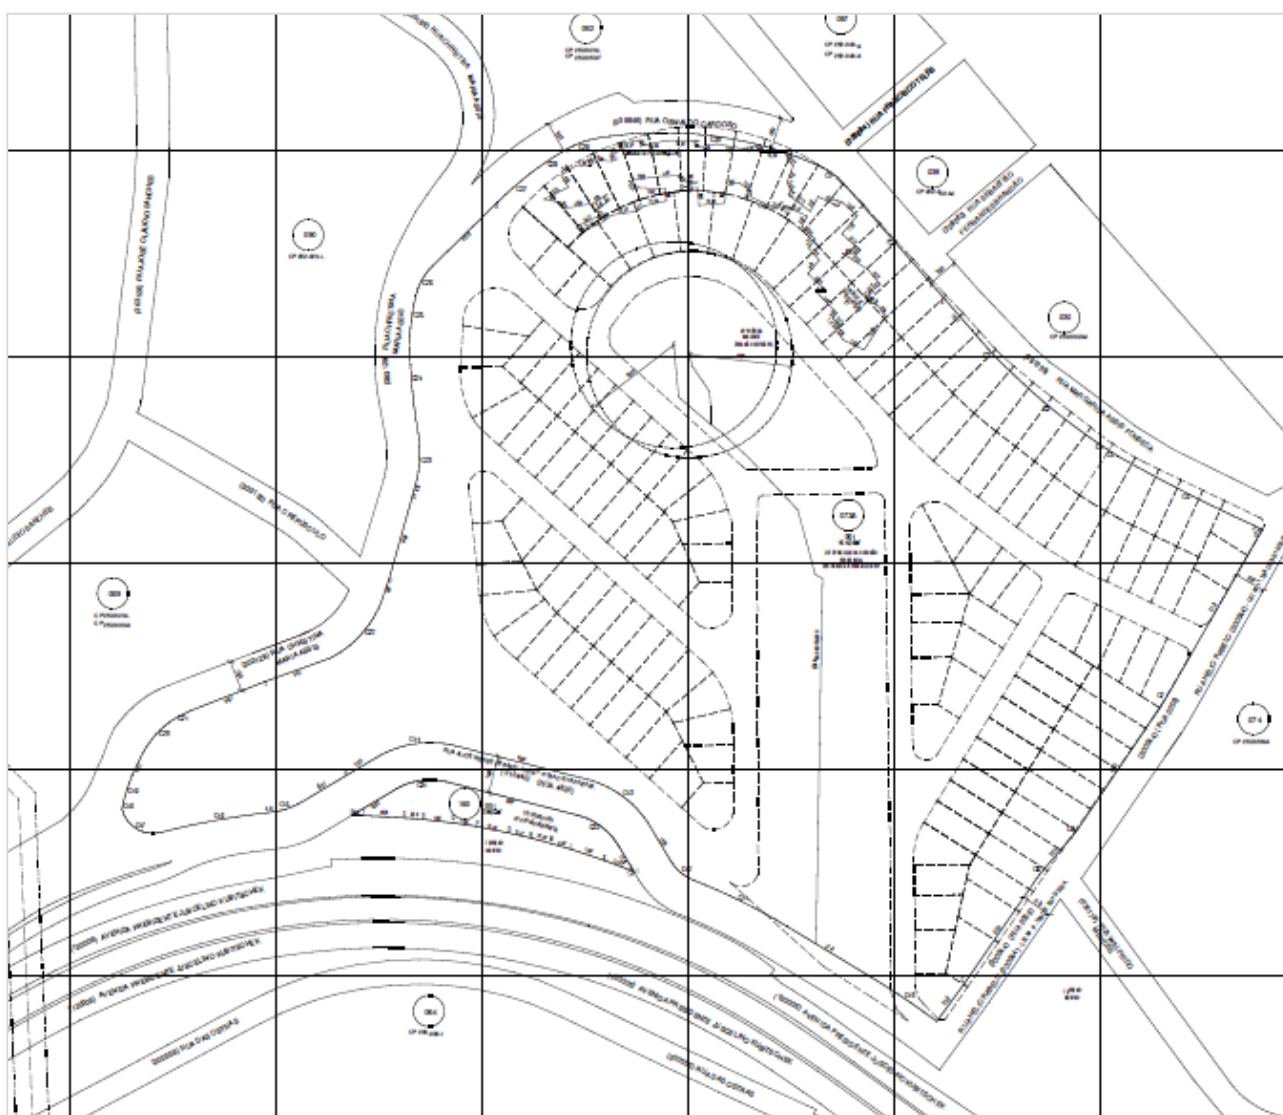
Planta CP 252-073-M. Fonte: PBH, 2020.
